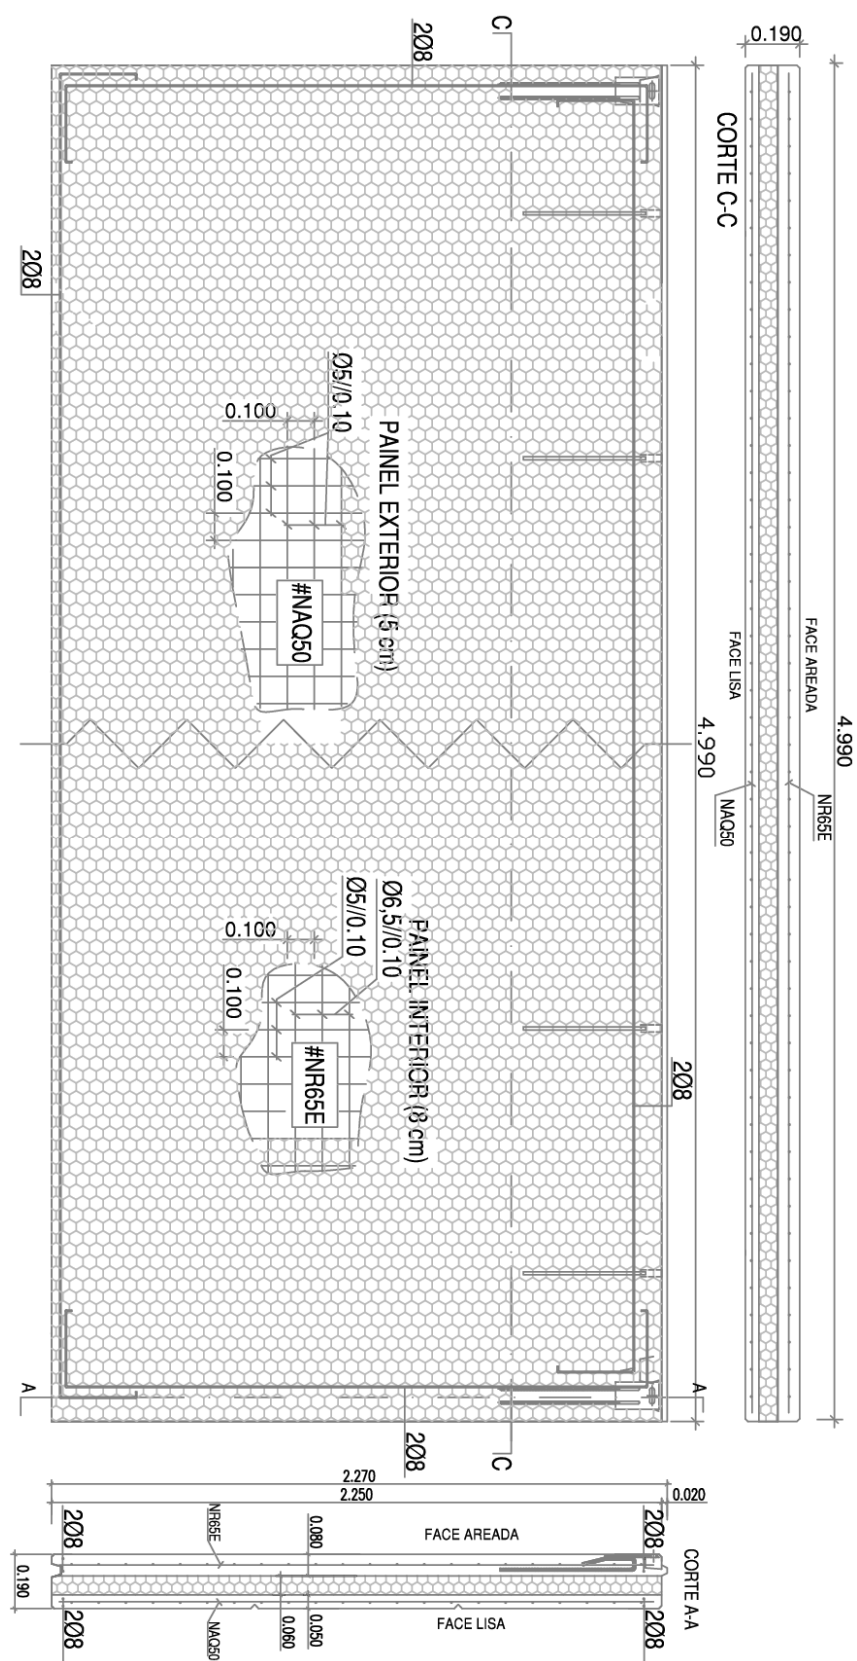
Pormenorização do Painel (sem escala) (Adaptada de Concremat, 2011)
